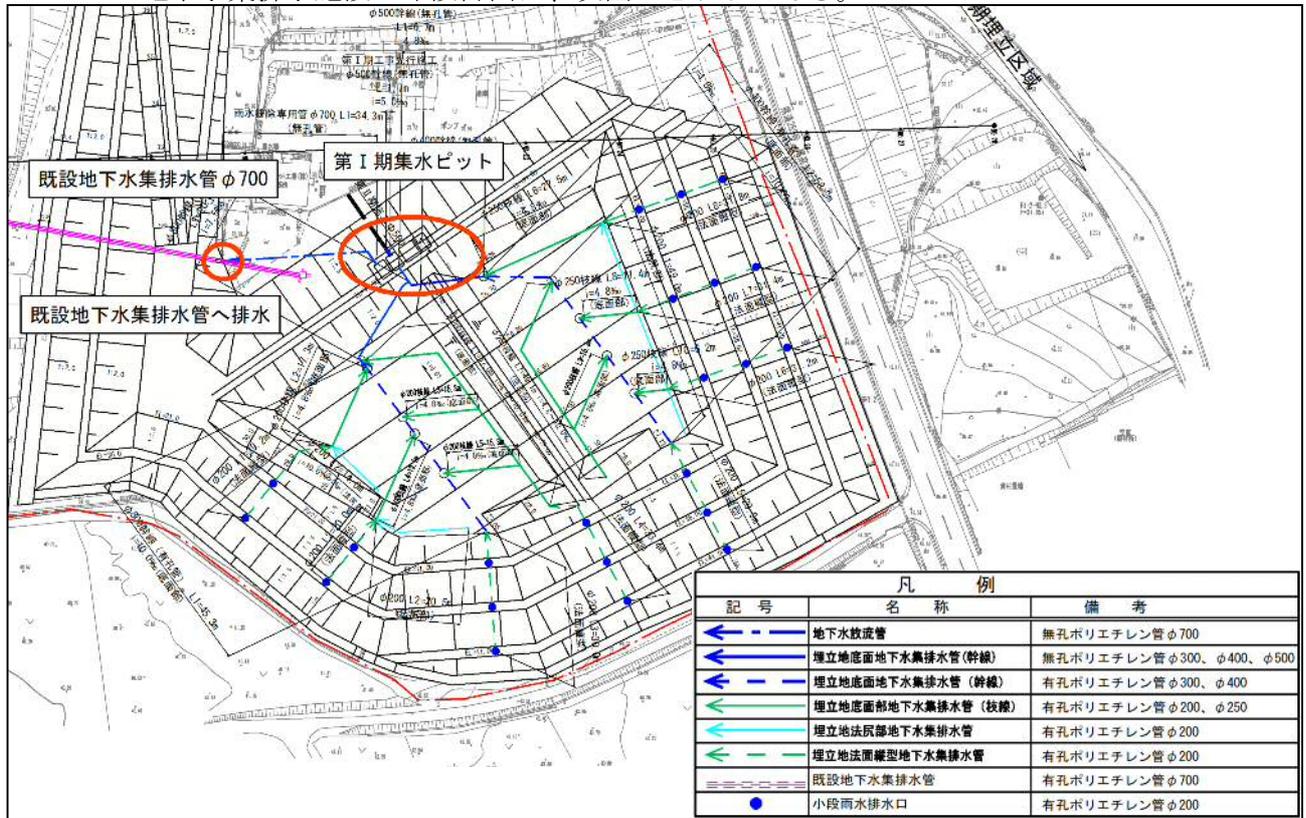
地下水集排水施設布設計画平面図 (第Ⅰ期)
